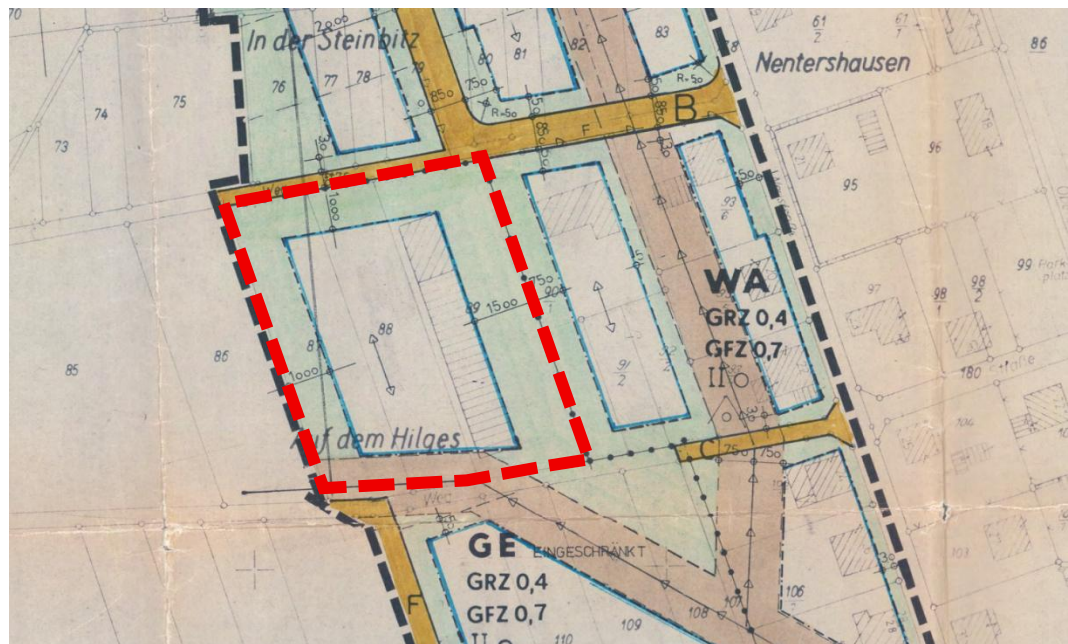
Auszug Ursprungs-BP "Steinbitz"; Geltungsbereich rot gestrichelt (unmaßstäblich)
